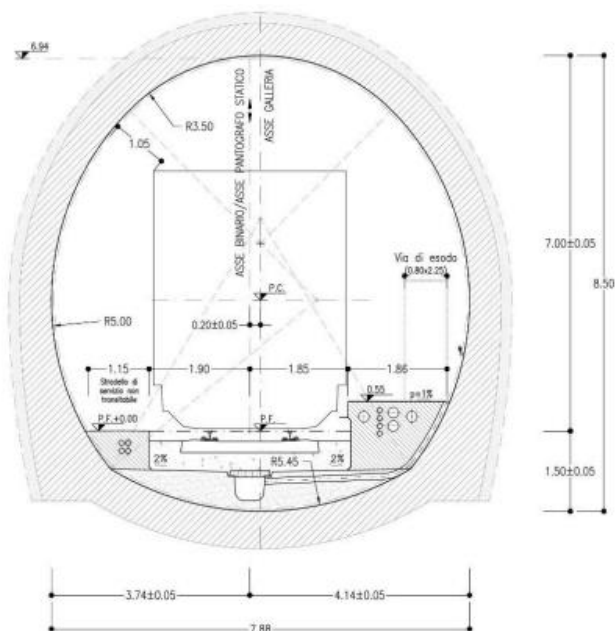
Sezione di intradosso galleria di linea a singolo binario per scavo tradizionale (sezione corrente)
